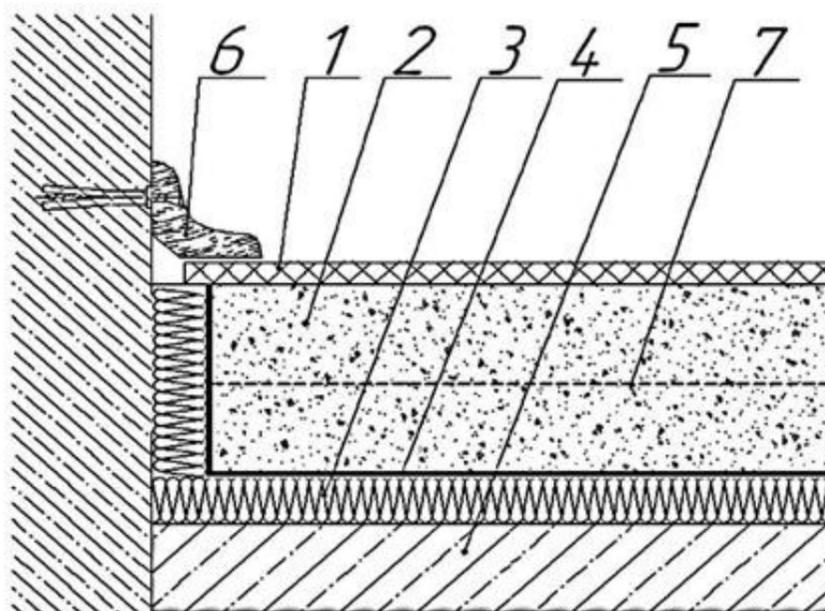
Типовой узел конструкции «плавающего» пола:
